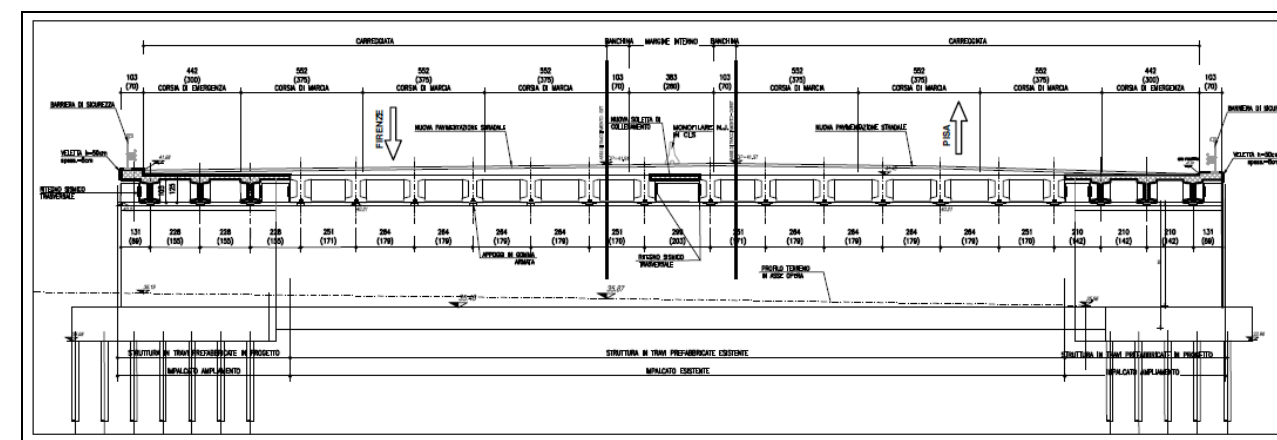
Ponte sul F. Reale. Sezione trasversale
